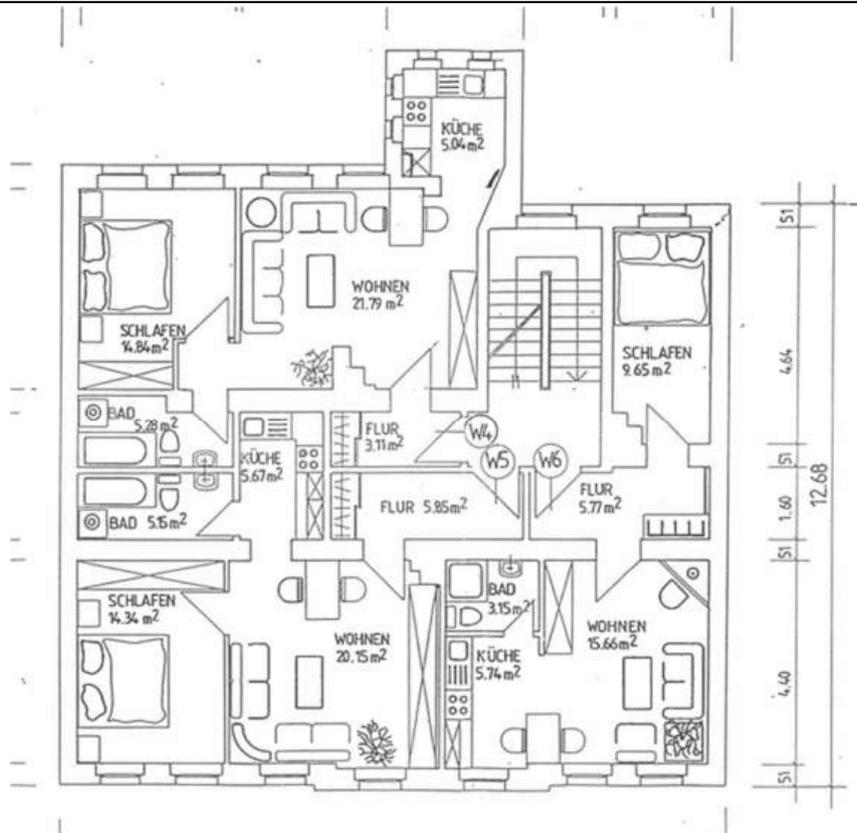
Grundriss 2. Obergeschoss
